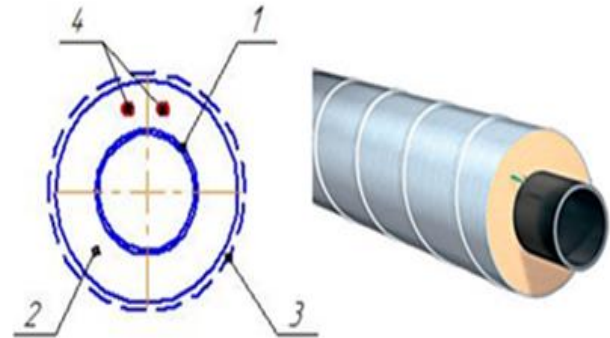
Попередньо ізольований трубопровід для наземної прокладки:
